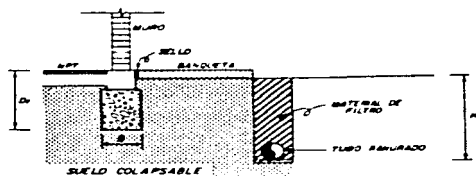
DENTELLÓN, MURETE Ó FALDÓN
